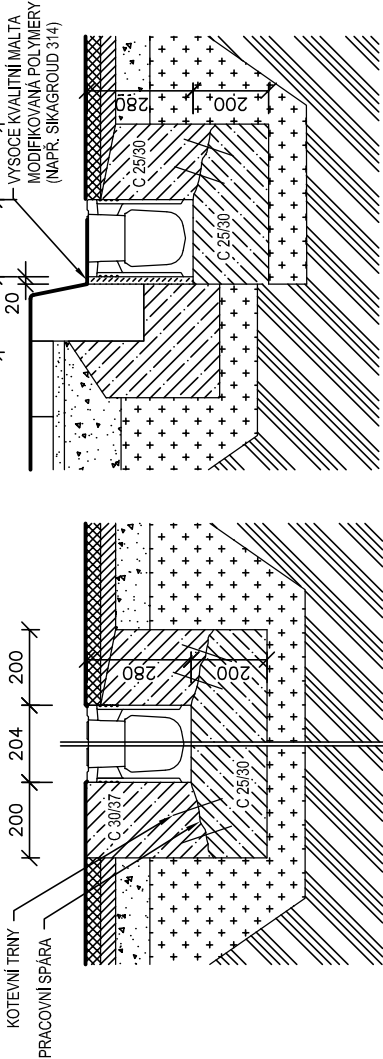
DETAIL INSPEKČNÍHO KUSU DM 1500.R
